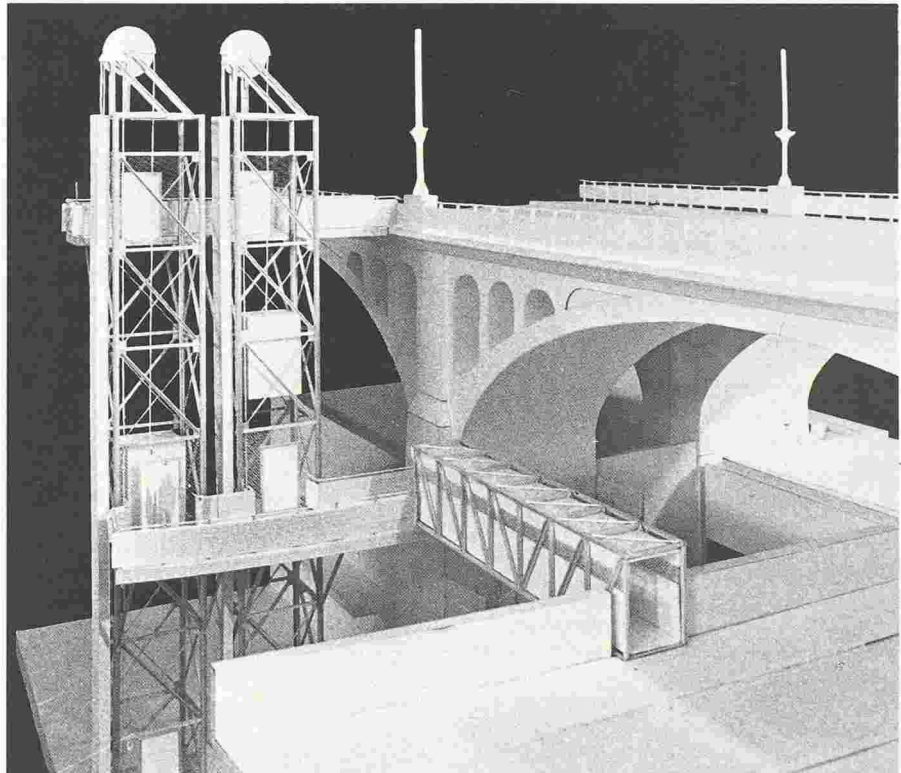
Ascenseurs reliant la station de La Vigie au niveau du pont Chauderon. (Photo de maquette.)
